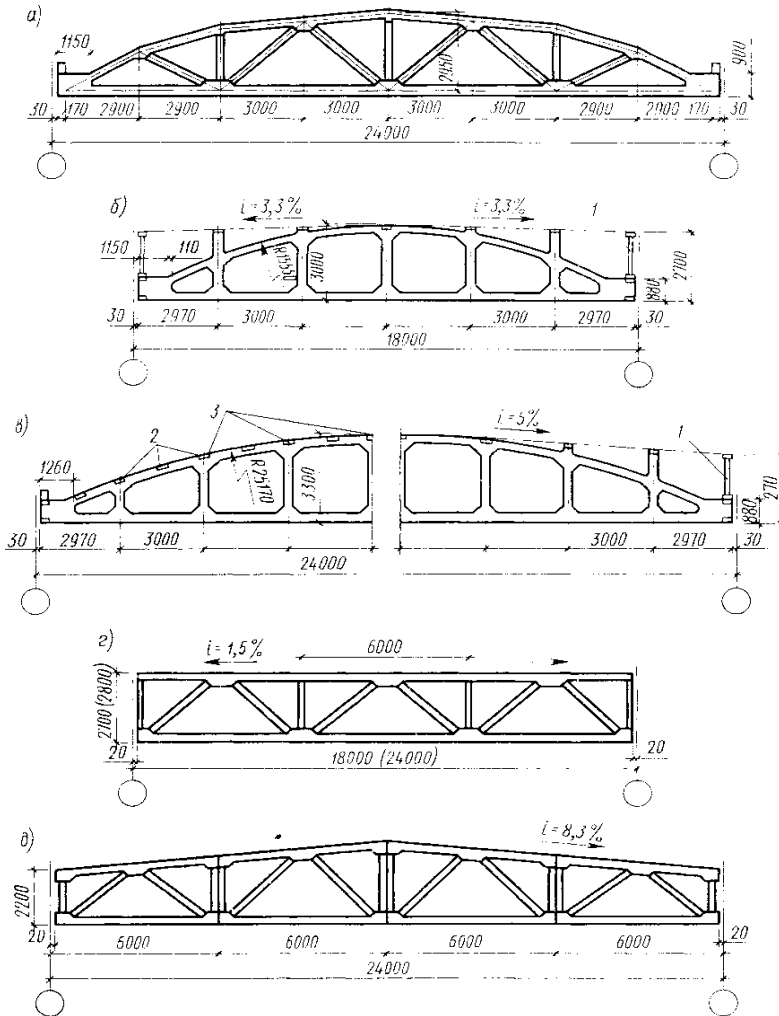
Залізобетонні кроквяні ферми: а - сегментна ферма розкосів; б, в - арокні ферми різних прольотів; г - ферма з паралельними поясами; д - кроквяна ферма з двохилим верхнім поясом; 1 - сталевий стійка; 2 - закладна деталь для плит шириною 1,5 м; 3 - закладна деталь для плит шириною 3 м
